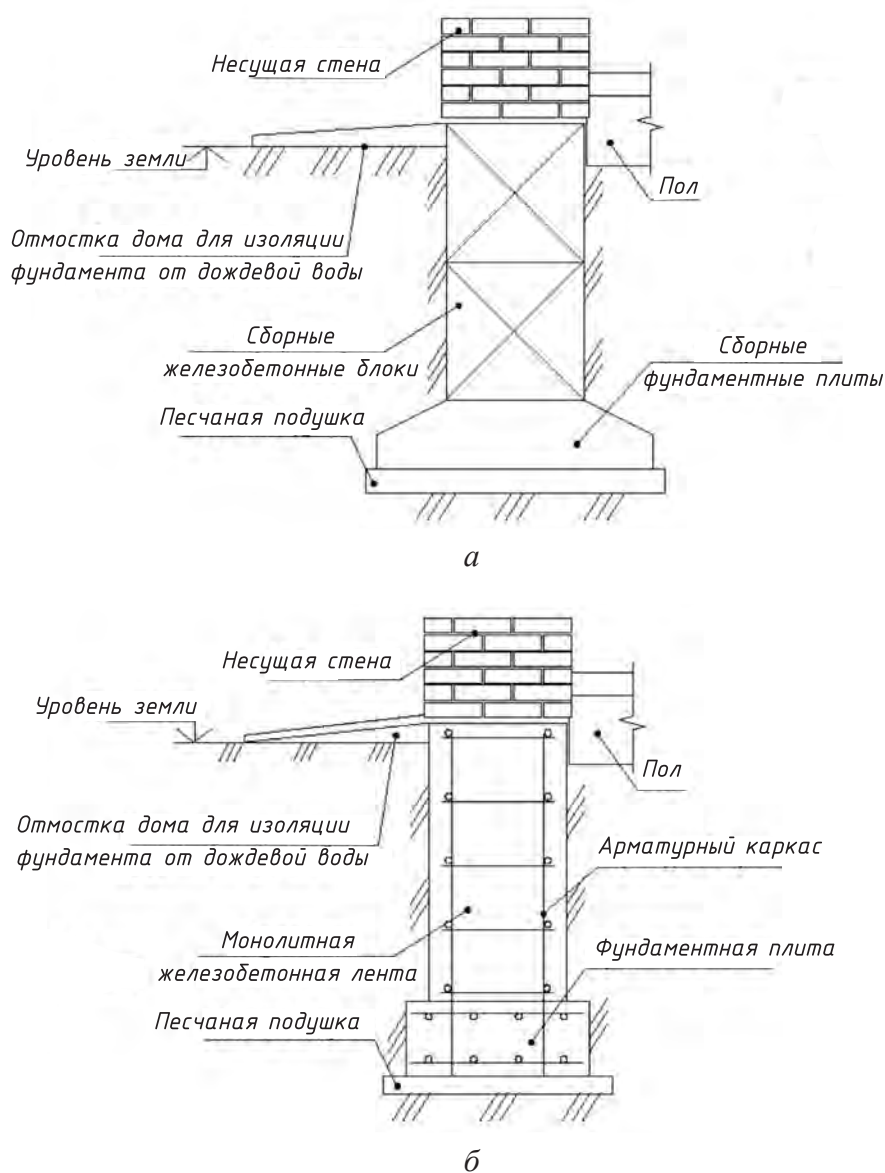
Конструкции ленточных фундаментов: а — ленточный сборный фундамент; б — ленточный монолитный фундамент
